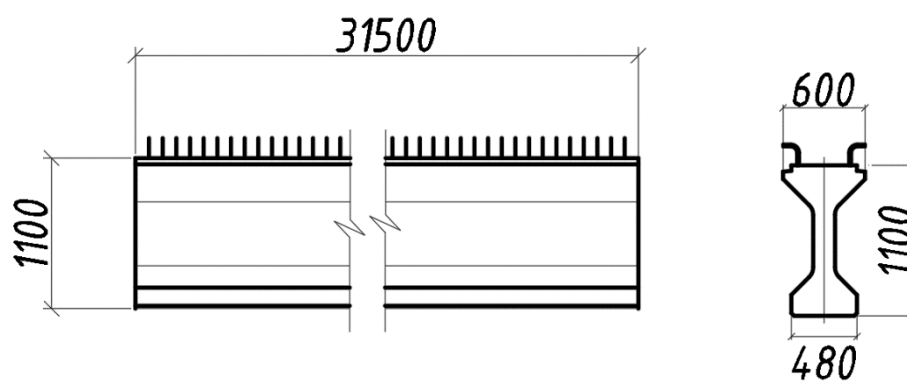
Попередньо напружена залізобетонна балка 31.5м
